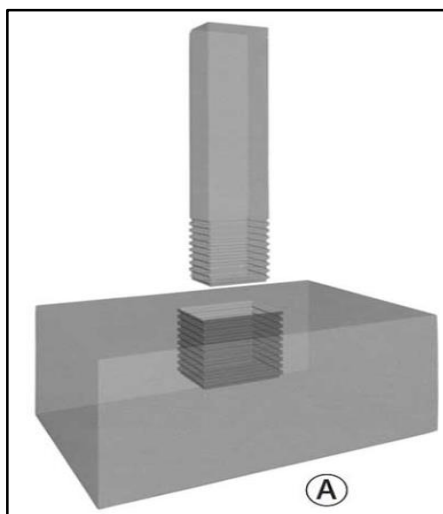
Conexión columna-zapata tipo candelero. Fuente: (Penagos Congote, 2017).
